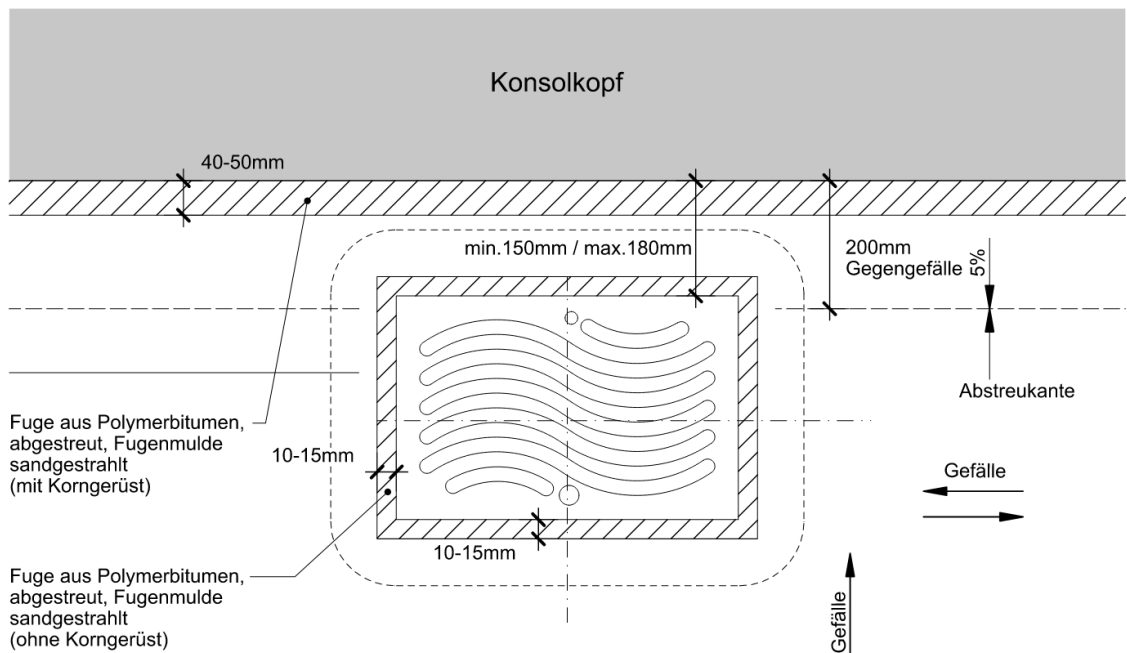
Detail Einlaufschacht Grundriss
